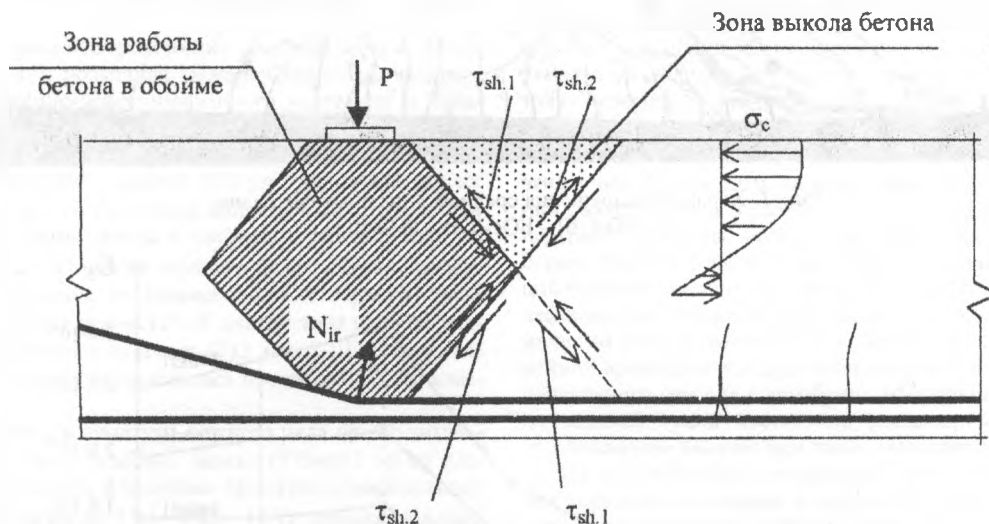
Схема работы балки с полого отогнутой арматурой в зоне максимальных изгибающих моментов
